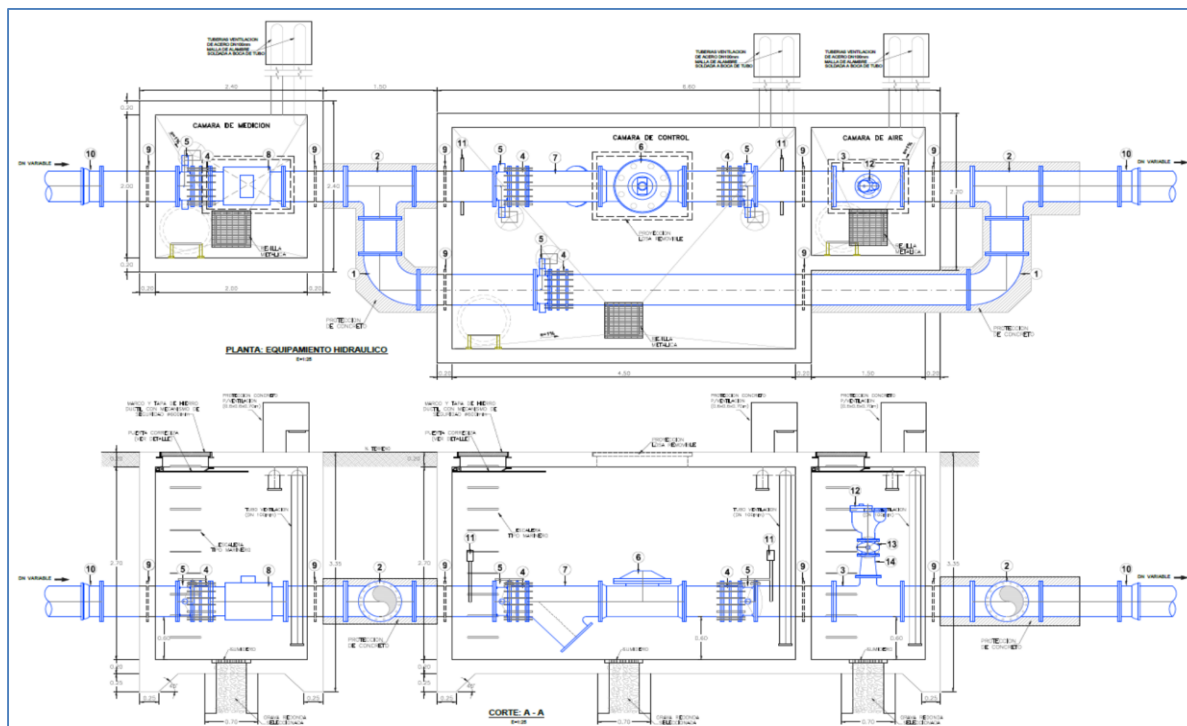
Vista en planta y corte de Cámara de Ingreso a Sector típico
